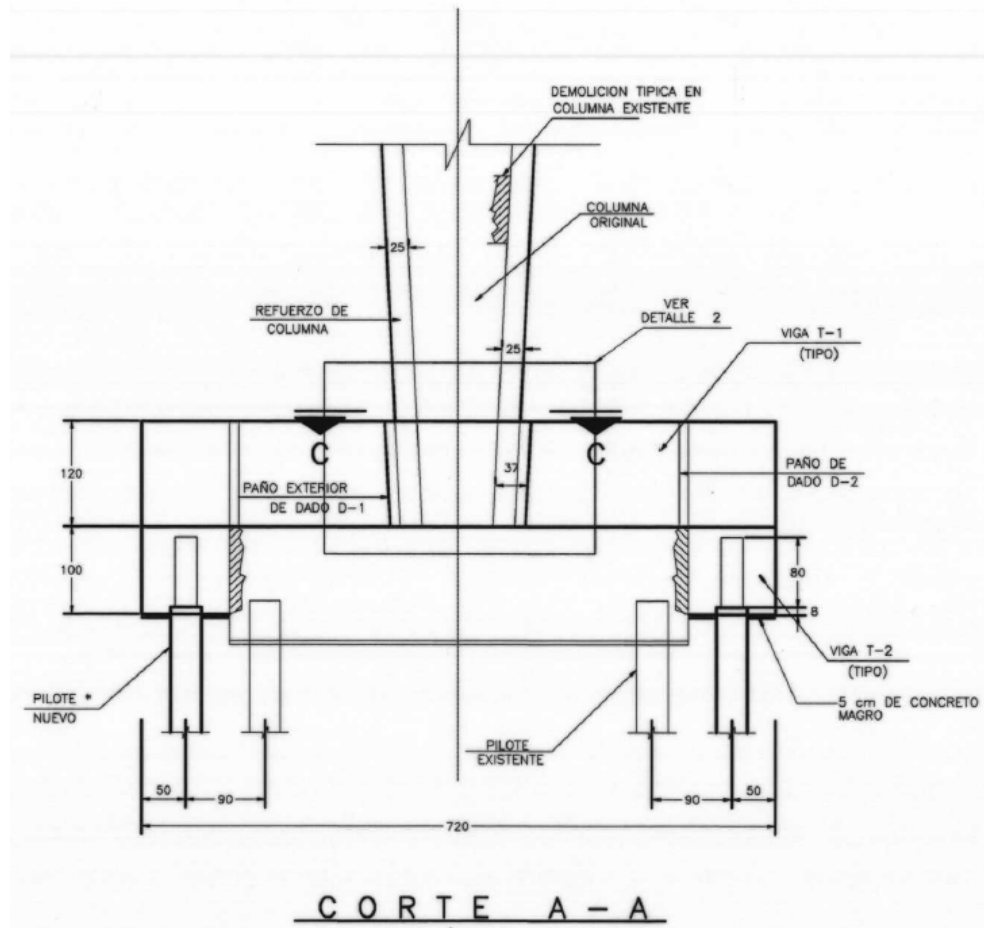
Cimentación típica de las pilas centrales del puente - Alzado. Proyecto original y de actualización sísmica
